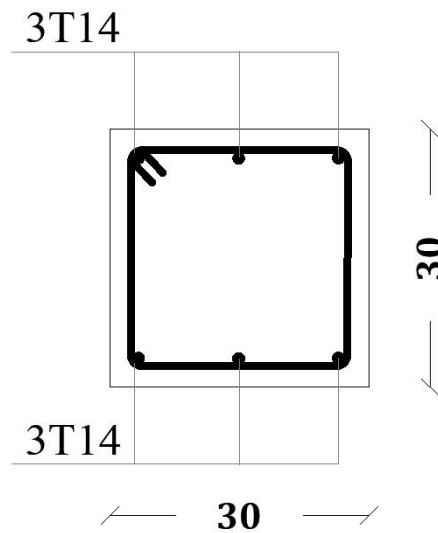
Schéma de ferrailage de la poutre noyée 30x30
